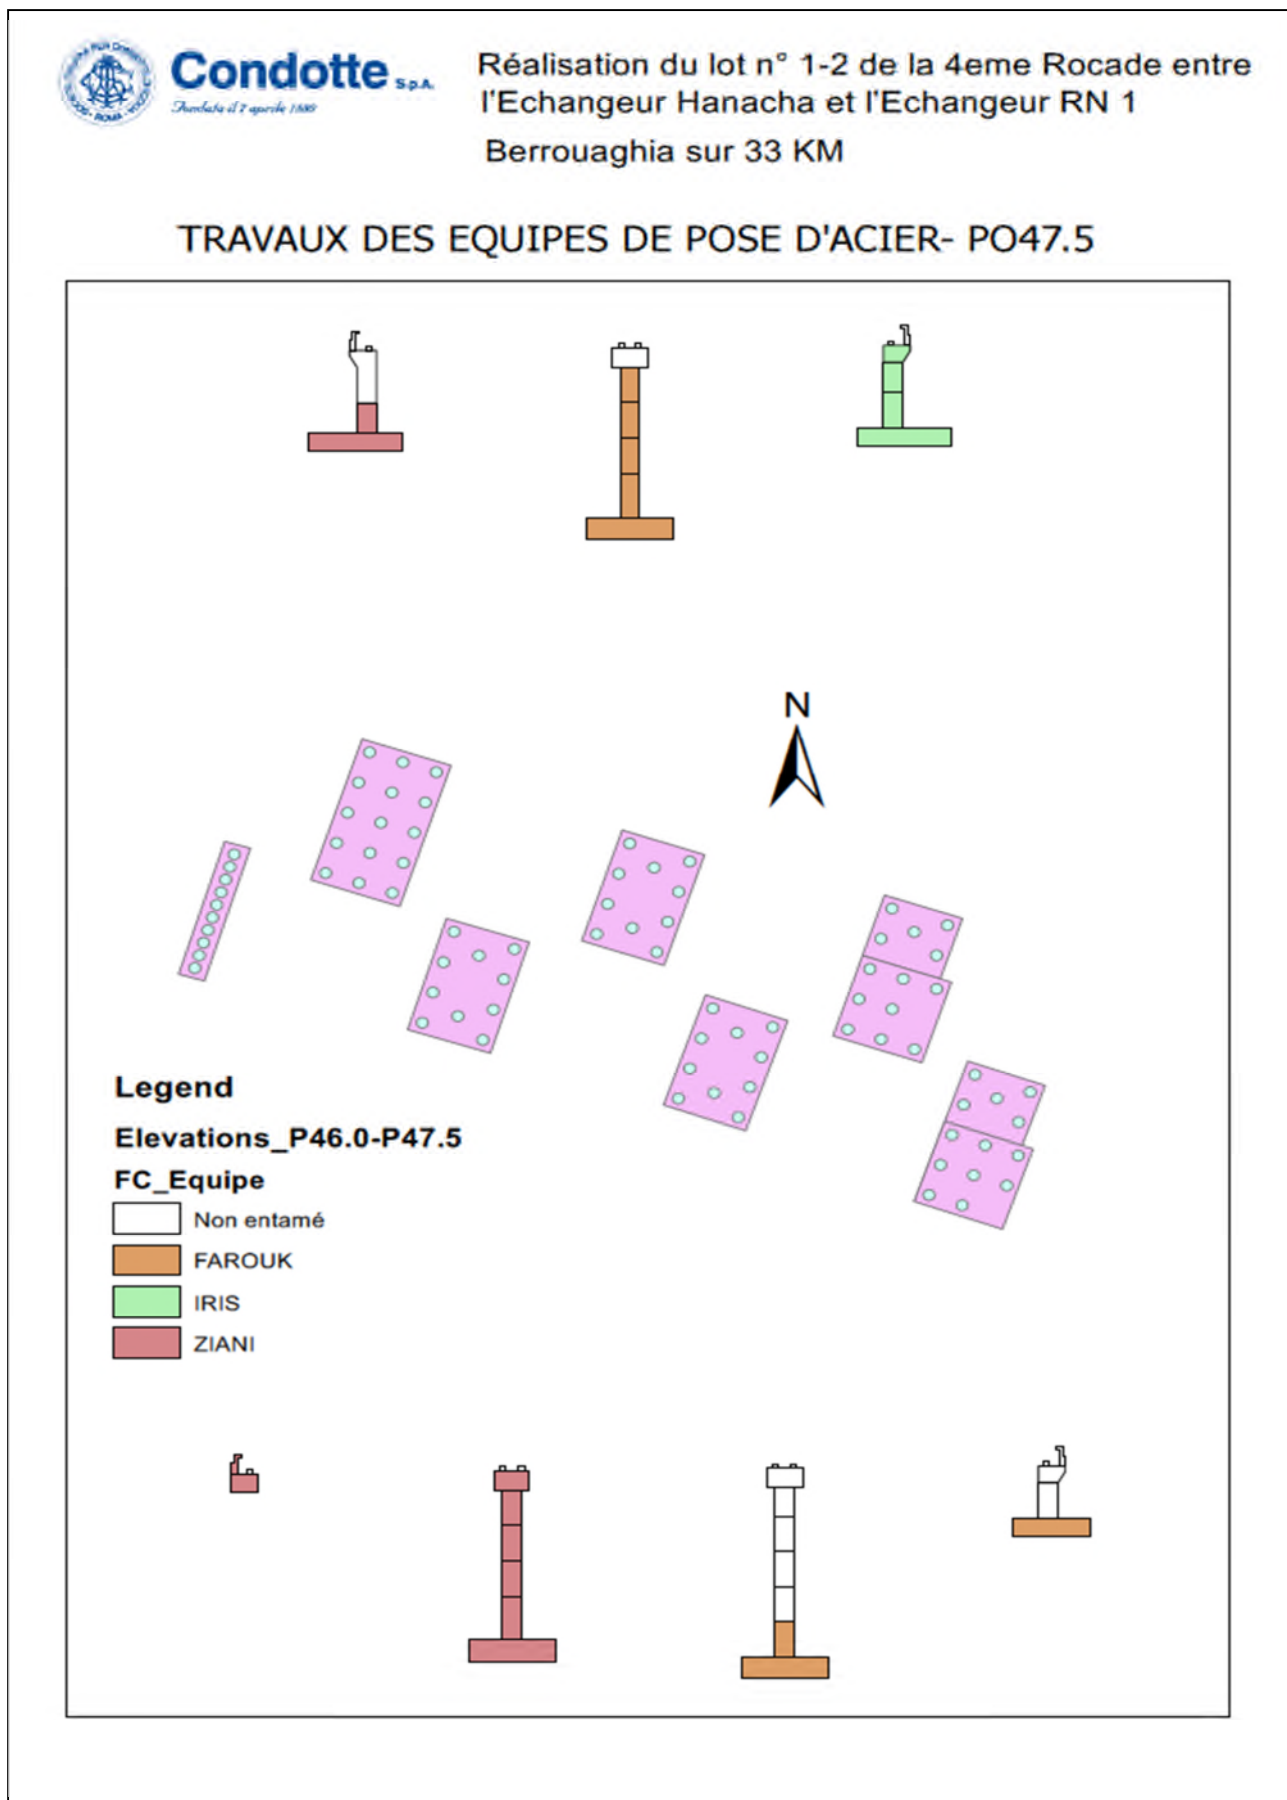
Travaux des équipes de Pose d'Aciers – Pont 47.5
